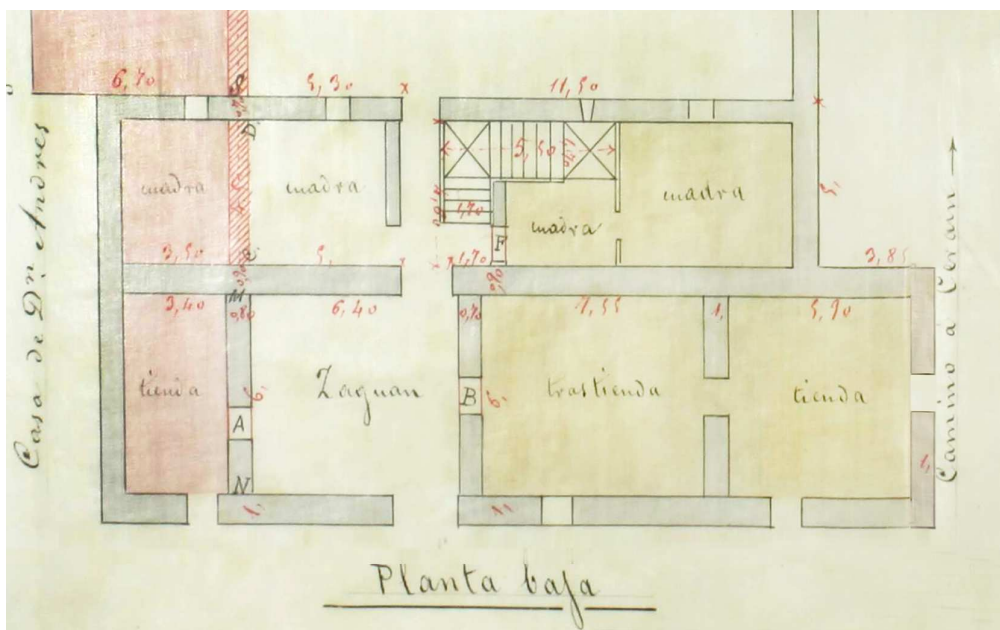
Planta baja del Palacio en 1888. Archivo Histórico de Protocolos (Oñate)
